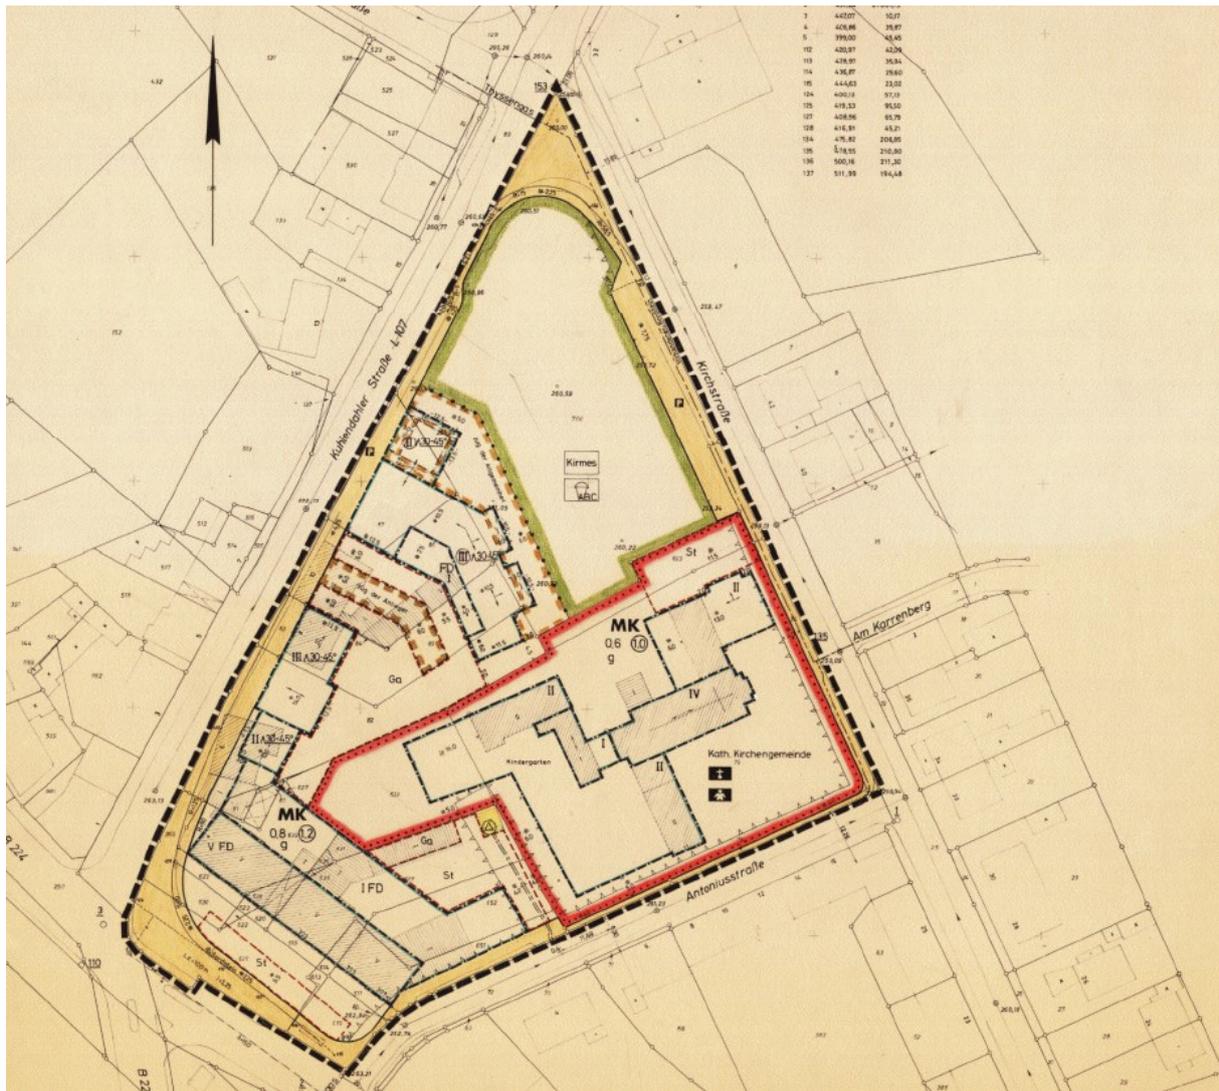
Darstellungen aus dem Bebauungsplan Nr. 503 – Kuhlendahler Straße -
